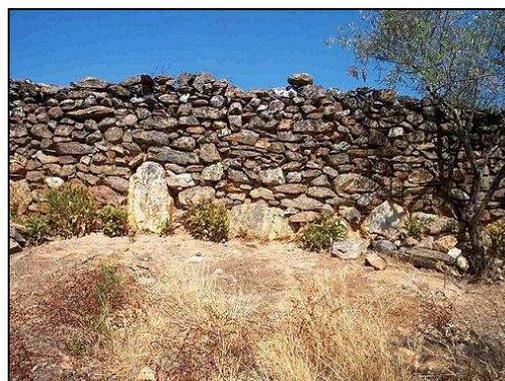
Aparelho com camadas horizontais mal ou pouco definidas.
